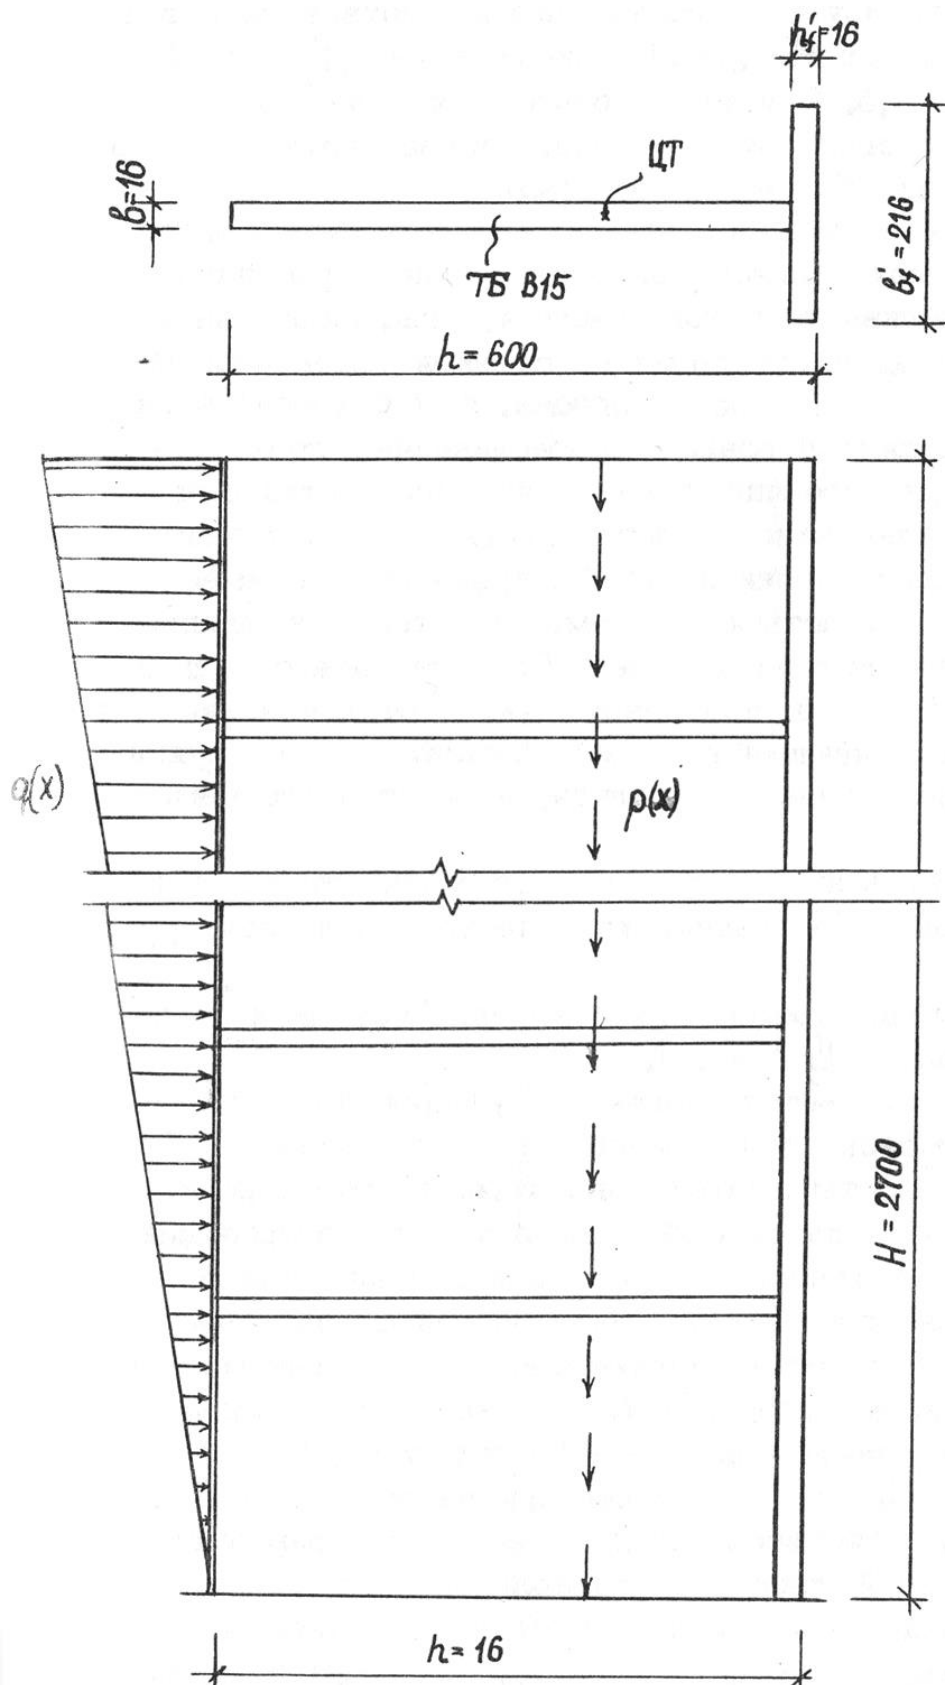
Действие продольной и поперечной нагрузки на бетонную стену таврового сечения
